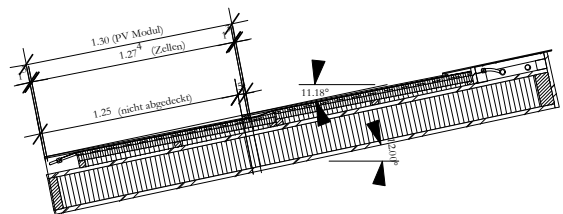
PT3, Detailschnitte Konstruktiver Aufbau.
